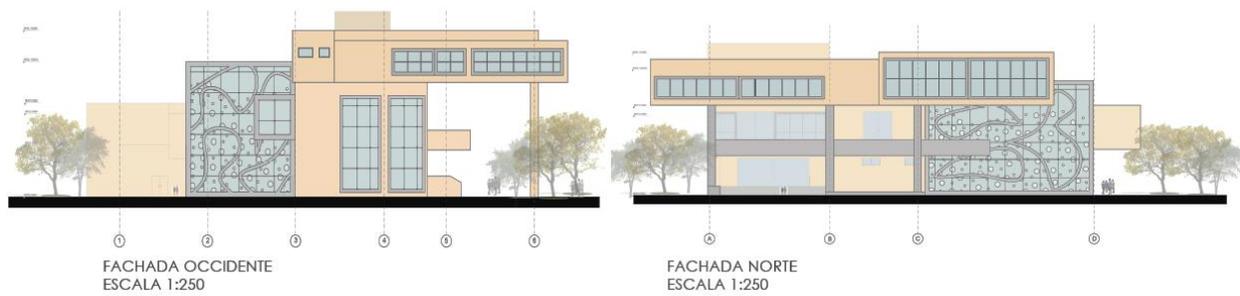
FACHADA OCCIDENTE Y FACHADA NORTE
